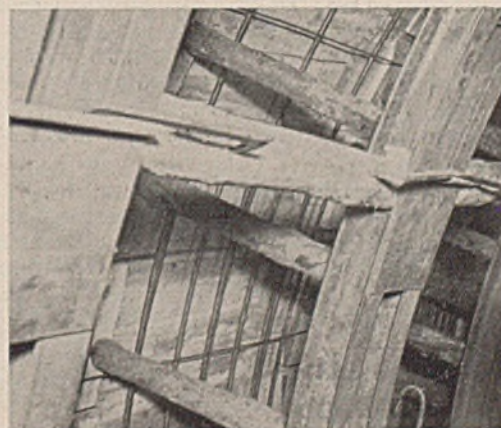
Einfache Bewehrung der Kämpfer. Im Vordergrund Spickeisen.
